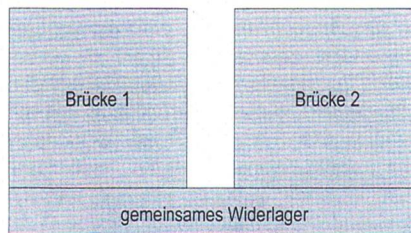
Zwei Brücken mit gemeinsamem Widerlager
